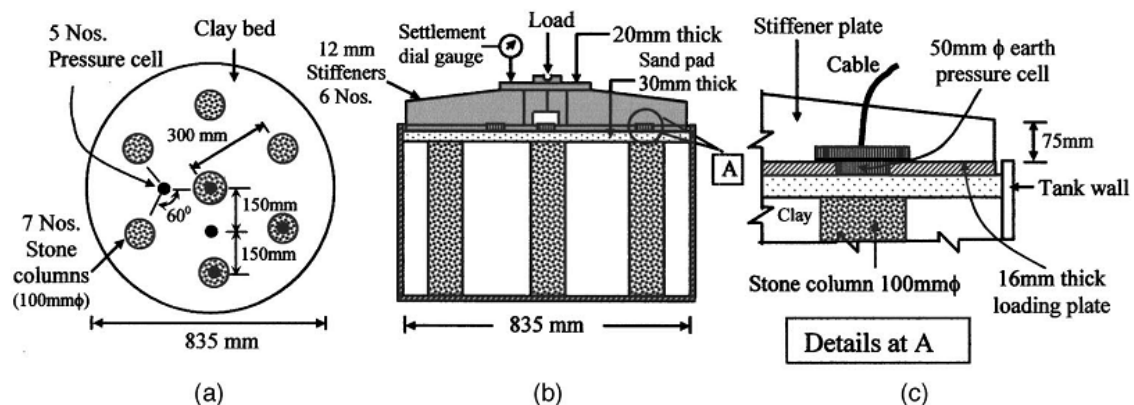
18 Essais de chargement sur modèle réduit des. a) vue en plan ; b) profile en travers ; c) détails de la cellule de pression. (Ambily et Ghandi, 2007)
